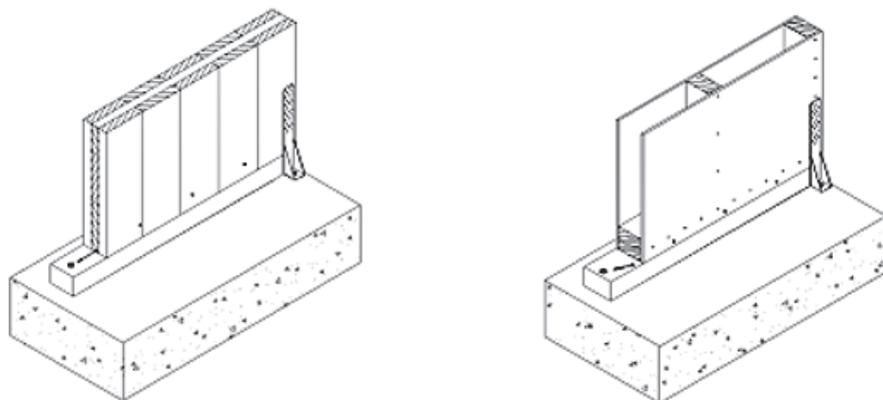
Appoggio della parete in fondazione con soglia di legno: collegamento a trazione mediante hold-down, collegamento a taglio tra parete e soglia mediante viti incrociate e tra soglia e fondazione mediante tasselli, rispettivamente per pannelli XLAM e intelaiati
